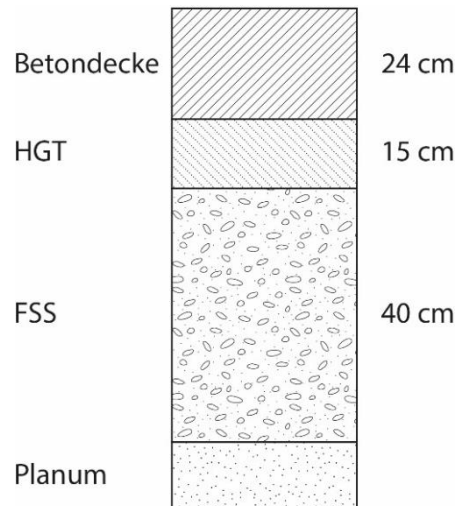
Strecke einer BAB mit 39 Jahren Liegedauer mit Betondecke auf HGT auf FSS
